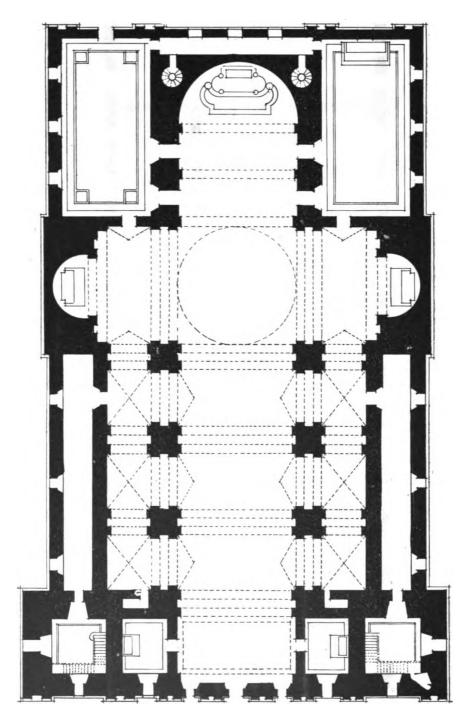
Río de Janeiro. — Planta aproximada de "La Candelaria"
